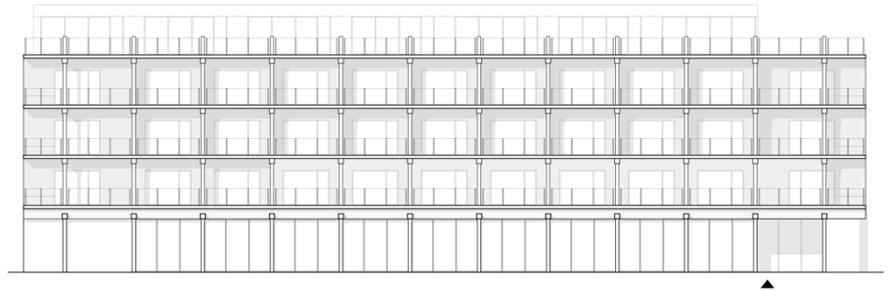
Fassadenansicht Dienstleister (original 1:200)
